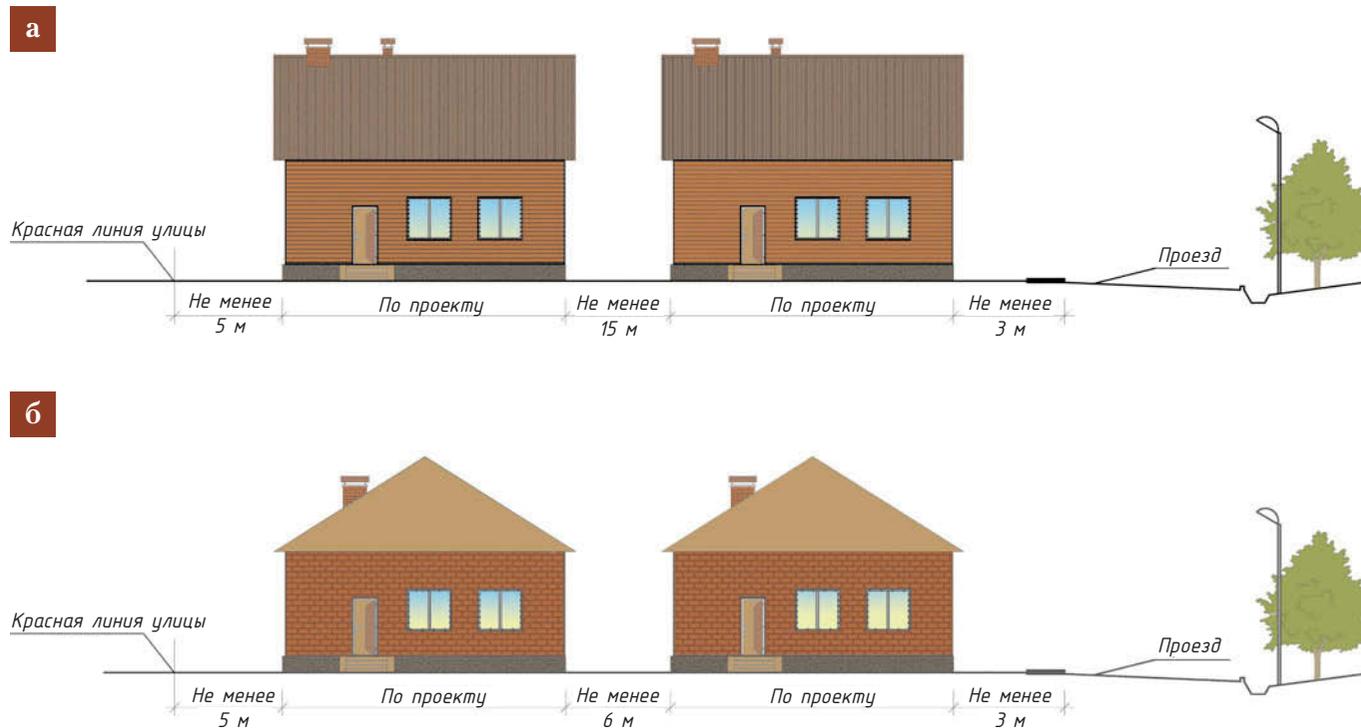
Нормативные расстояния между домами, красными линиями и проездами: *а* — дома с деревянными стенами; *б* — дома с каменными стенами и монолитными перекрытиями
